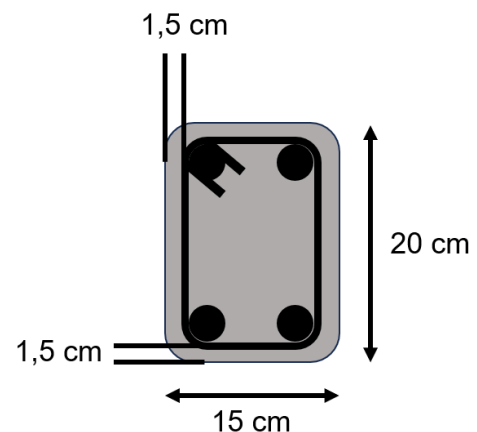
Detail Struktur Pondasi Bangunan Sederhana
